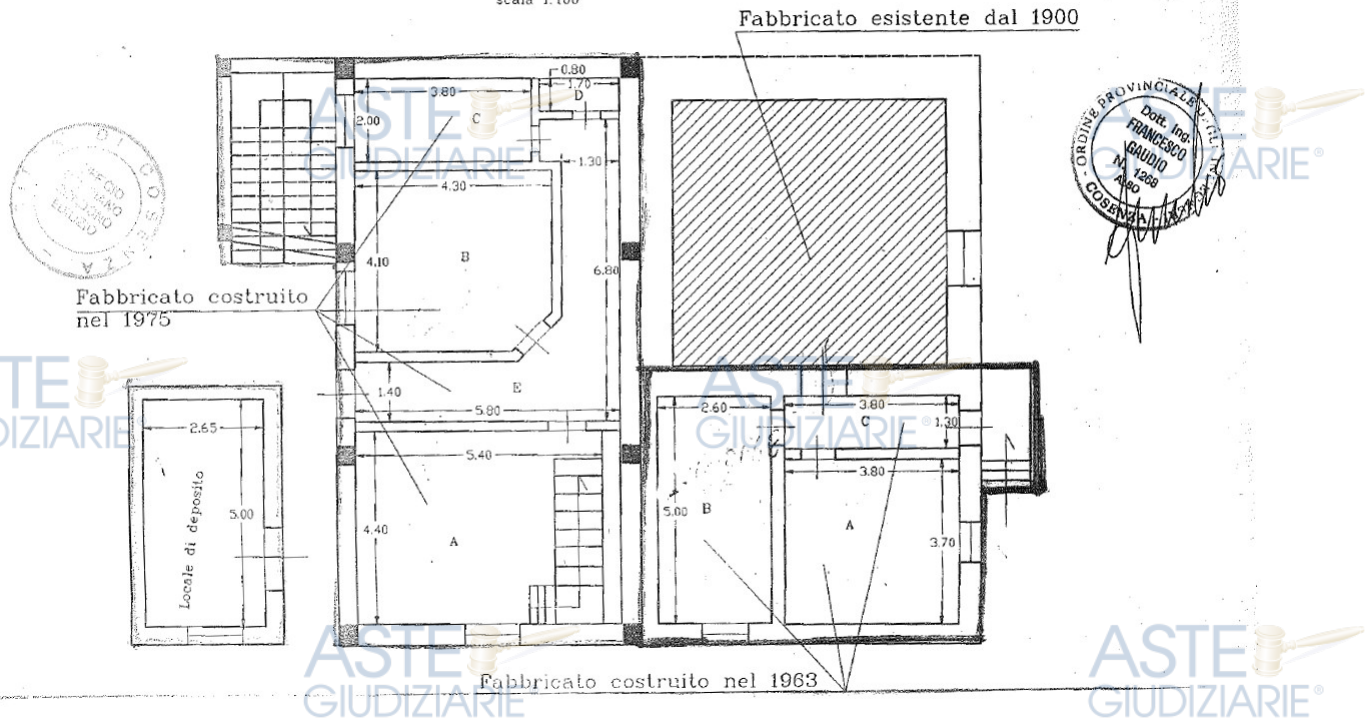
Planimetria in integrazione alla domanda di condono - Piano terra.
